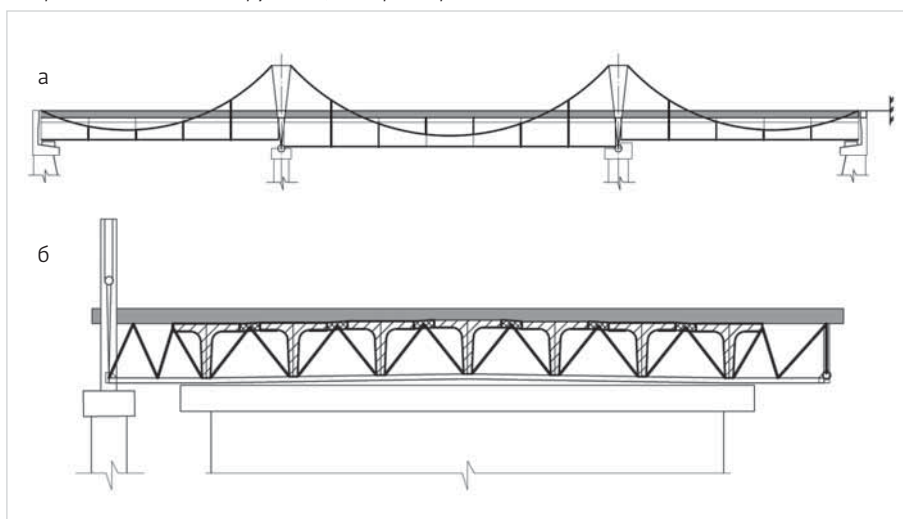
Реконструкция железобетонного пролетного строения с пролетами в свету 15–20 м
